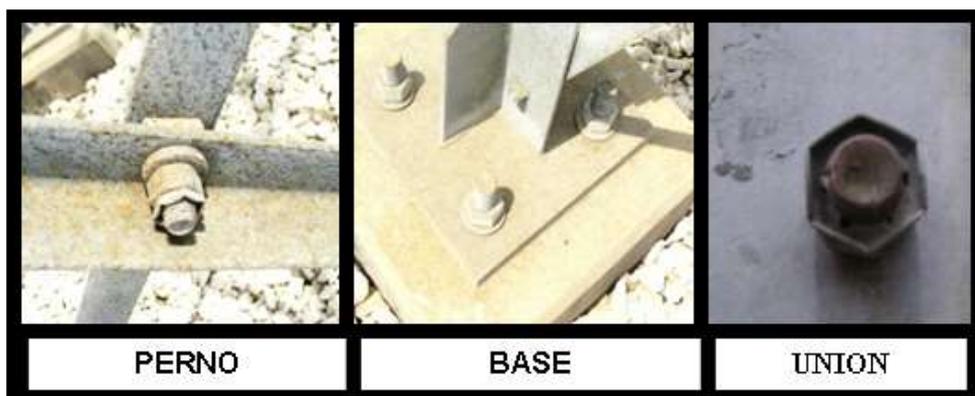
DESTRUCCION DEL GALVANIZADO DE UNIONES SOLDADAS, BASES Y PERNOS
